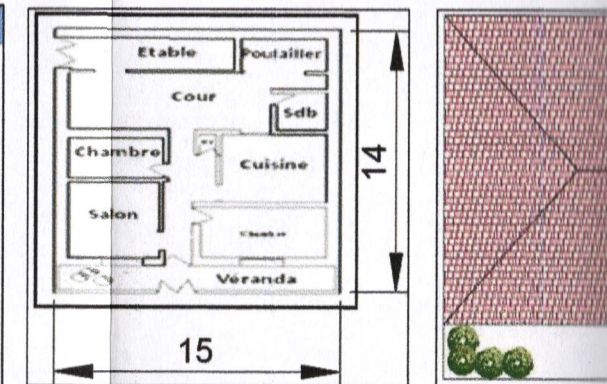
Exemple d'un plan et plan de toit d'une maison coloniale. Source : Auteurs.
